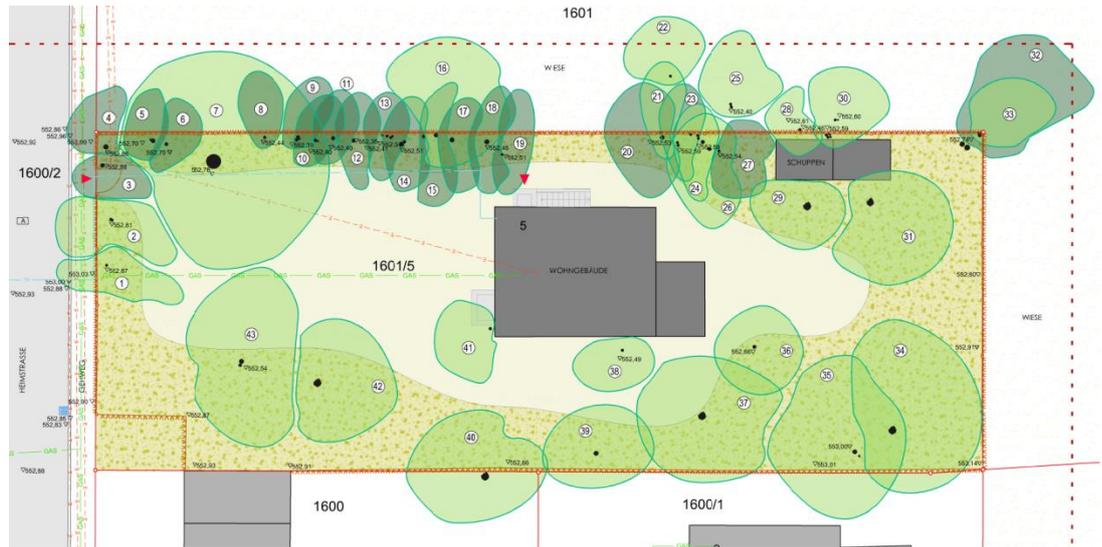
Baumbestandsplan Fl.St. 1601/5, o. M., Quelle: Landschaftsarchitekt Andreas Roest.
